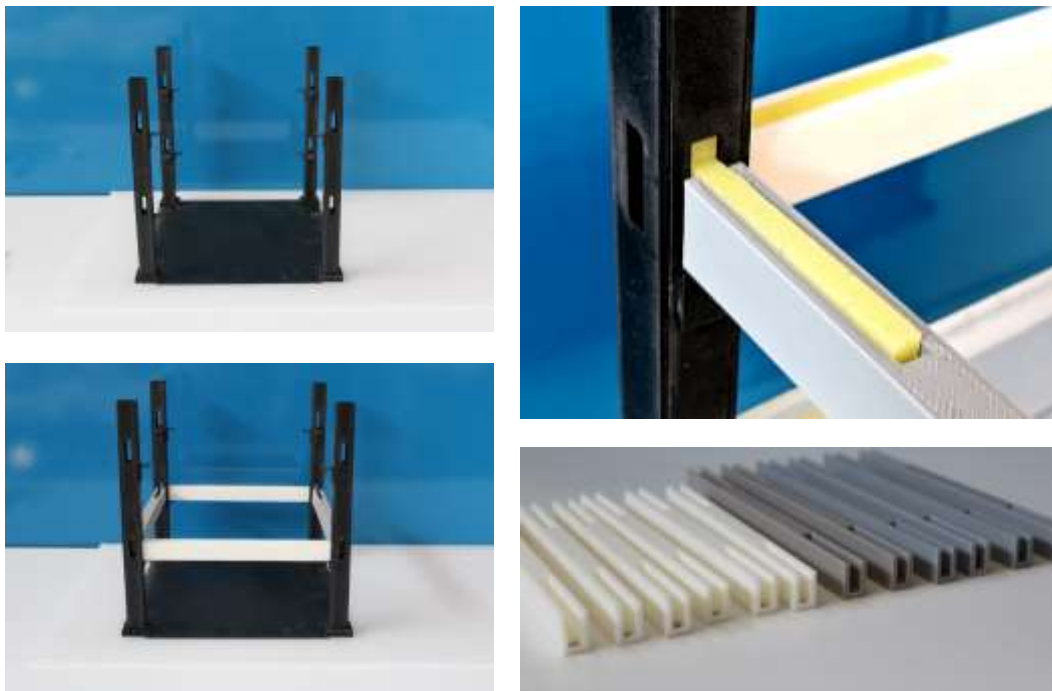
Colocación de vigas "U" prefabricadas apoyadas en ménsulas metálicas provisionales.
